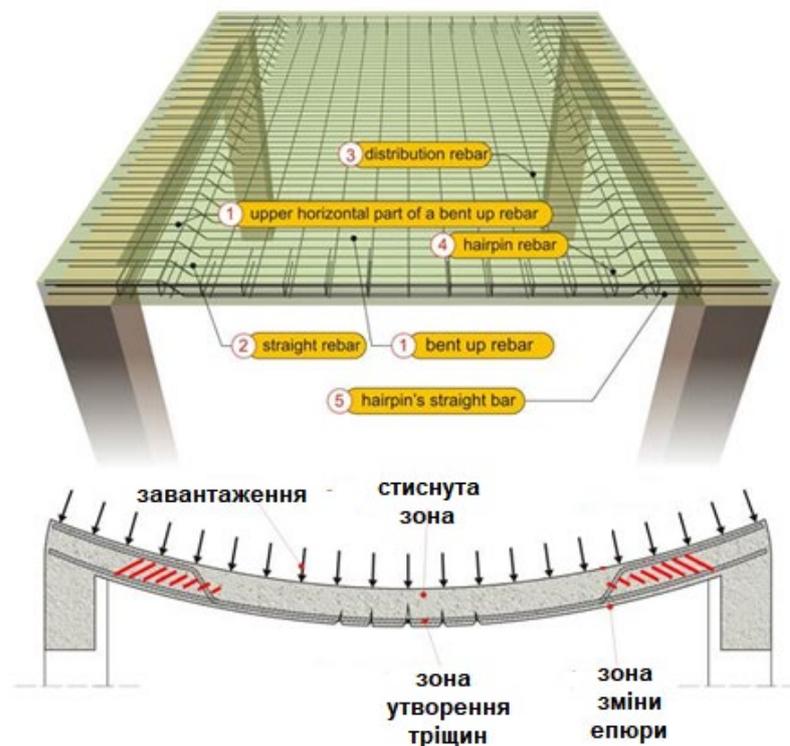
Схема розташування ариатури у монолітній плиті: 1 – відігнутий вгору арматурний стержень; 2 – прямий стержень плити; 3 – арматурна сітка; 4 – зігнутий стержень; 6 – Прямий стрижень з відігнутими кінцями.
